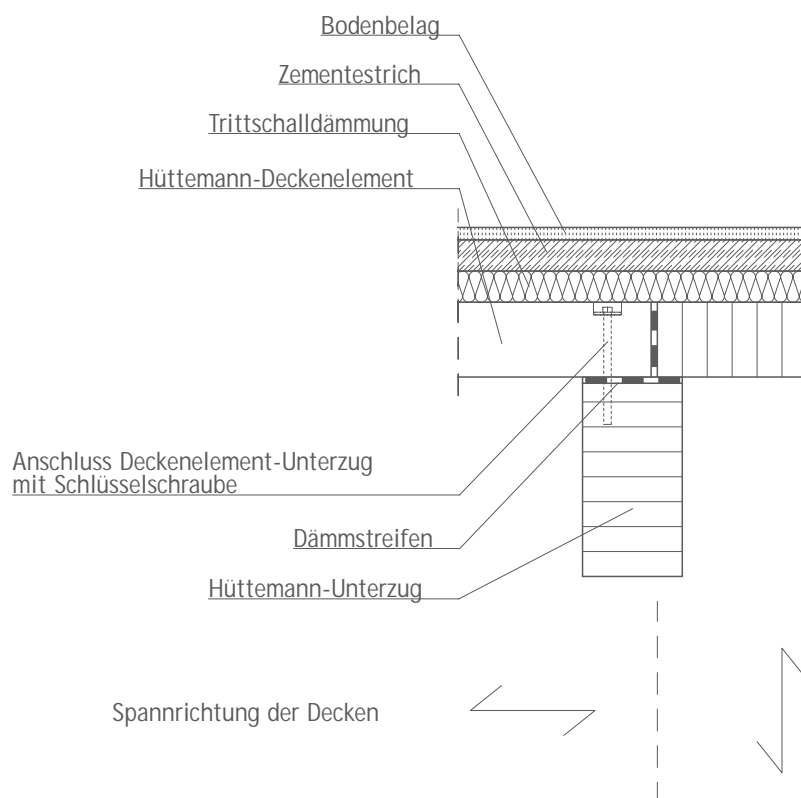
ANSCHLUSS DECKENELEMENT-UNTERZUG
